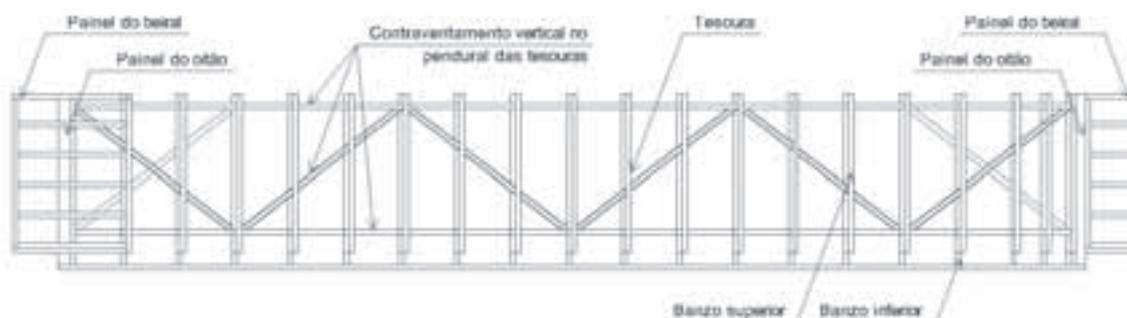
Vista lateral de estrutura de telhado mostrando o contraventamento em “X” do sistema de tesouras
